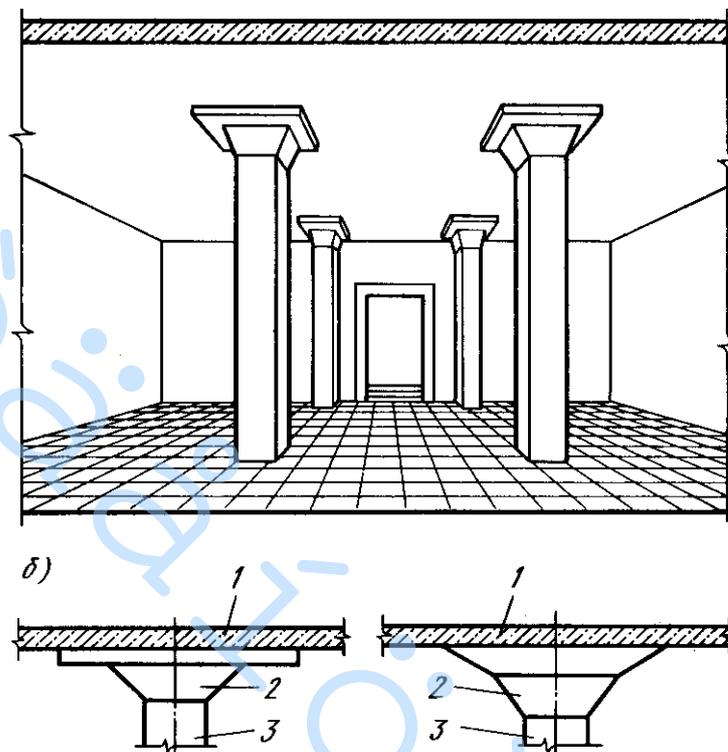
Железобетонное монолитное безбалочное перекрытие:
